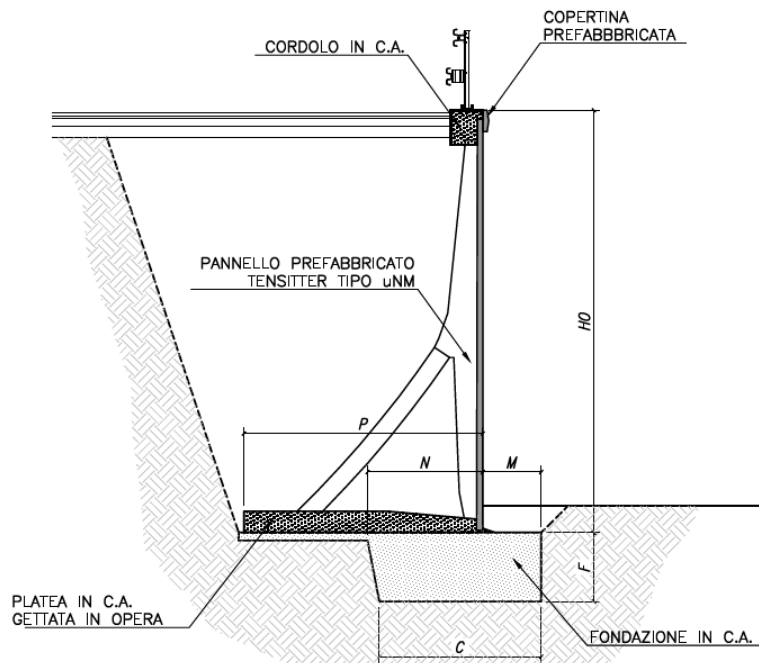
Sezione tipologica muro prefabbricato di tipo "uNM"
